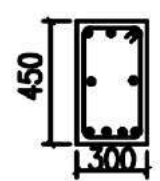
Penulangan Balok Basement – Lantai 1
